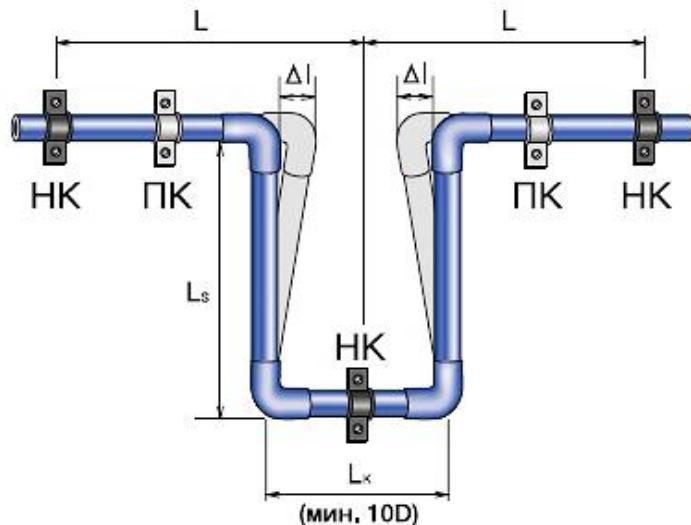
Крепление петли компенсатора неподвижной опорой к стене здания
